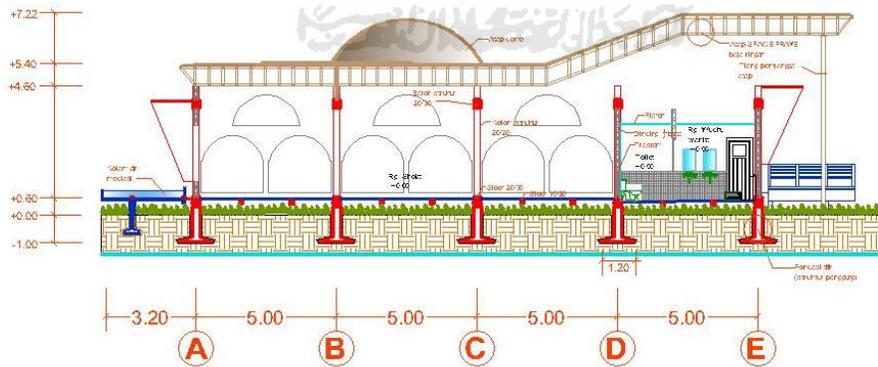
Potongan Bangunan Restoran dan Lounge
